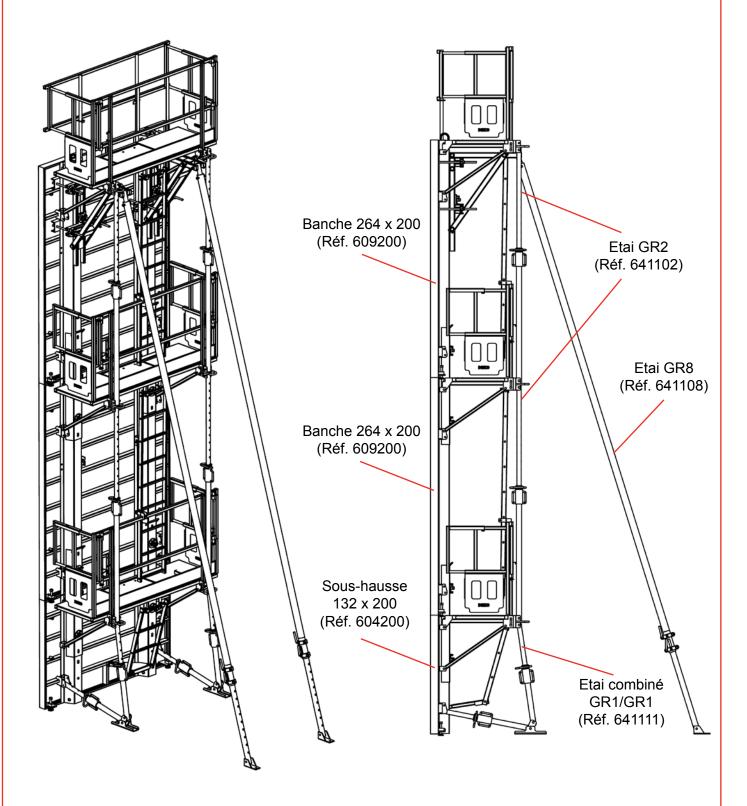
a : 2 banches 264 x 200 superposées + 1 sous-hausse, étayage vertical et stabilisation
